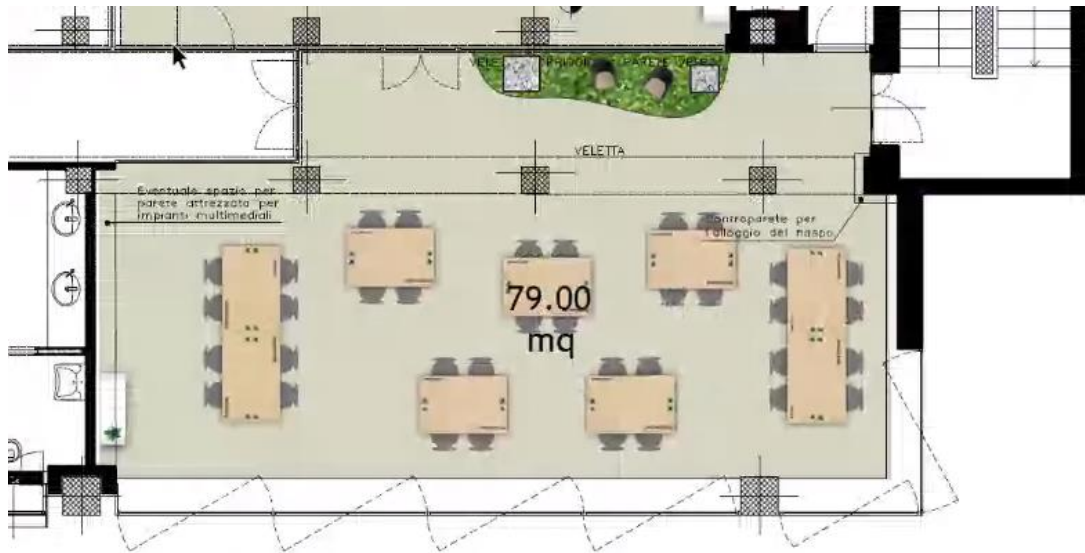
Planimetria della Training Room 1, spazio di Fondazione Agnelli che ospita il laboratorio "COMBO"
